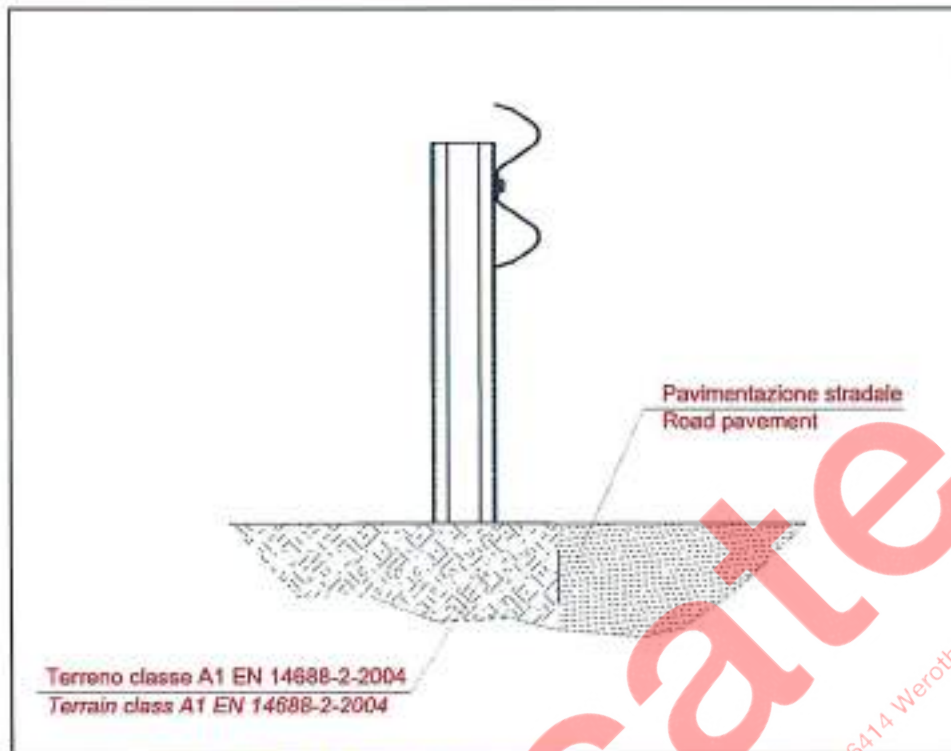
Figure 2 Sezione dell'installazione - The installation section
